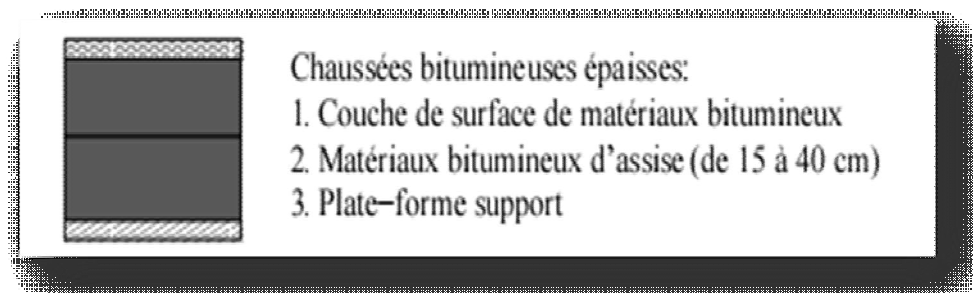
Chaussée bitumineuse épaisse [LCPC, 1994] [1].
